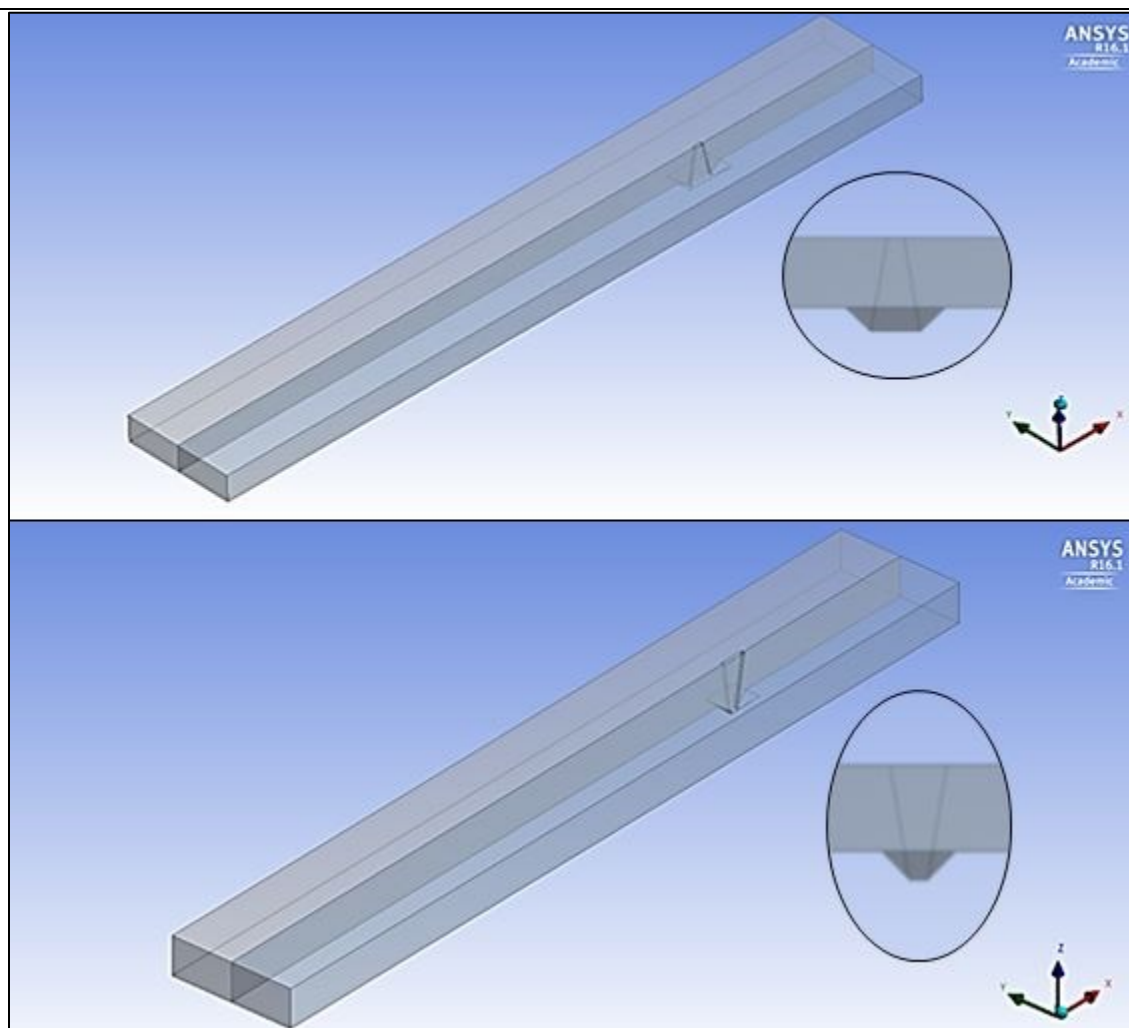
Escenario del cauce con el fondo erosionado alrededor del pilar.
